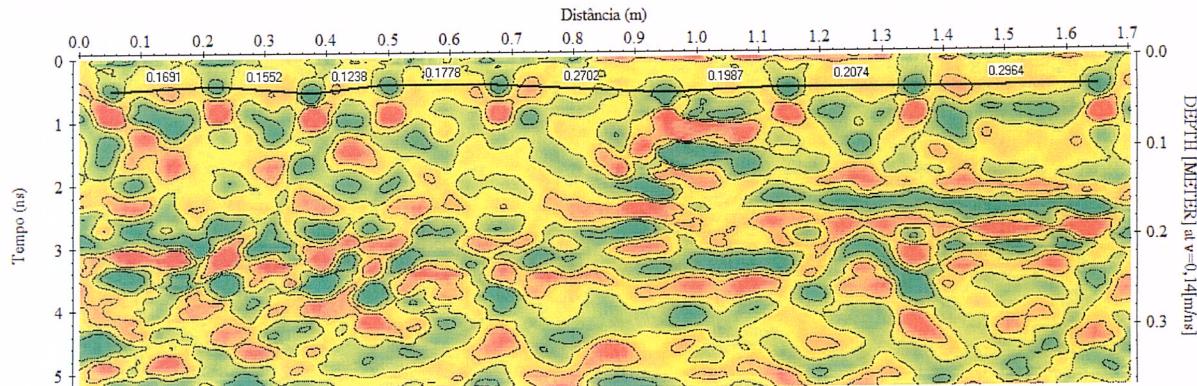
Radargrama da seção horizontal, na face oeste da Viga 1. Identificados refletores de barras de armadura transversal espaçadas entre si a distâncias de 17, 16, 12, 18, 27, 20, 21 e 30cm.
